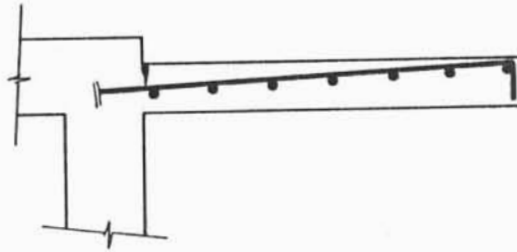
Fissura da laje em balanço por deslocamento da armadura da posição correta.
